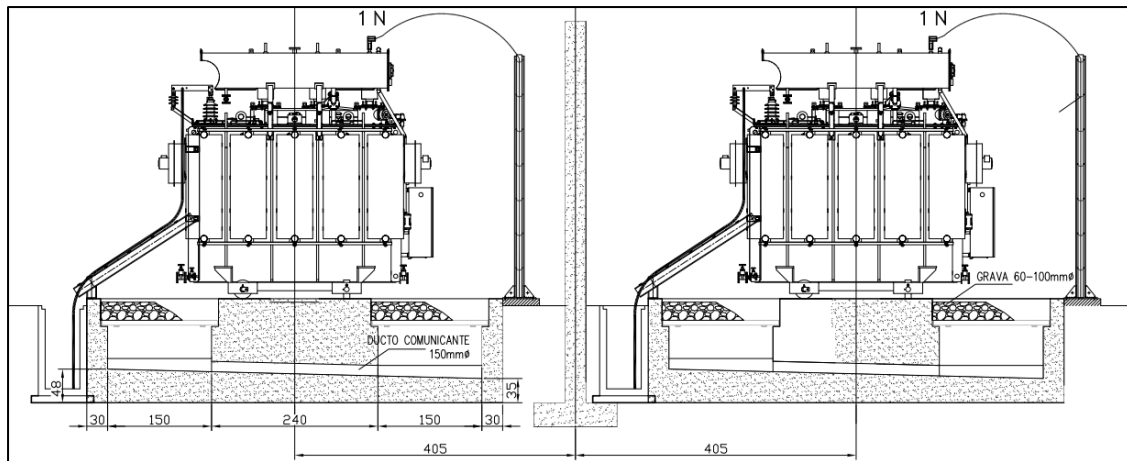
Muro corta fuego que separa los transformadores de la planta. Fuente: Autores.
